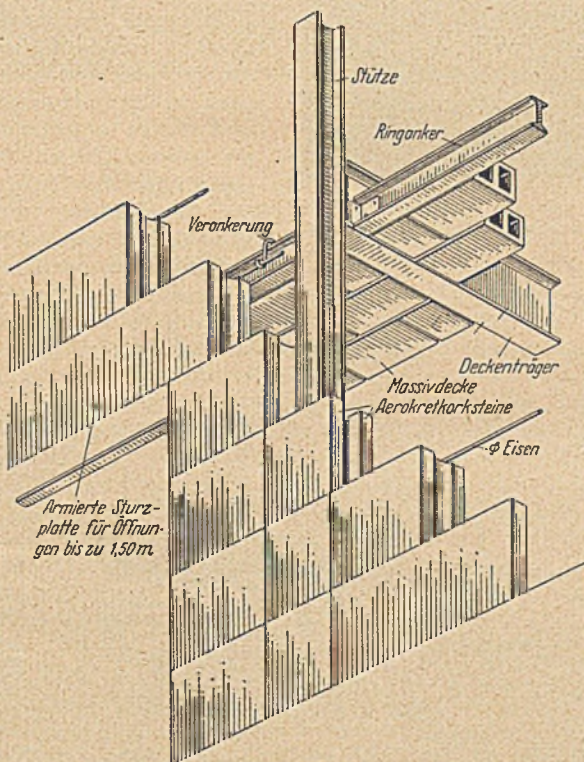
Konstruktions-Schema für Stahlskelett mit Gasbetonplatten.
